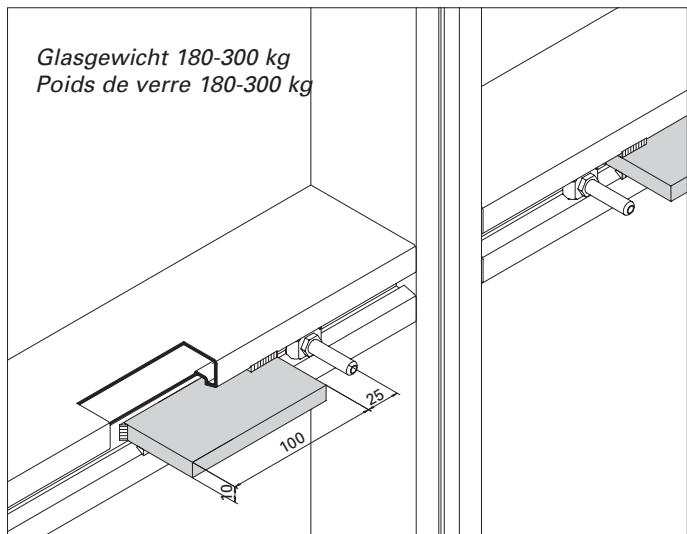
Spezial-Glasaufage (Glasgewicht 180-300 kg) gefertigt aus Flachstahl 100x10 mm, im Bereich VISS-Nute eingeschweißt (siehe Abb. 27).
